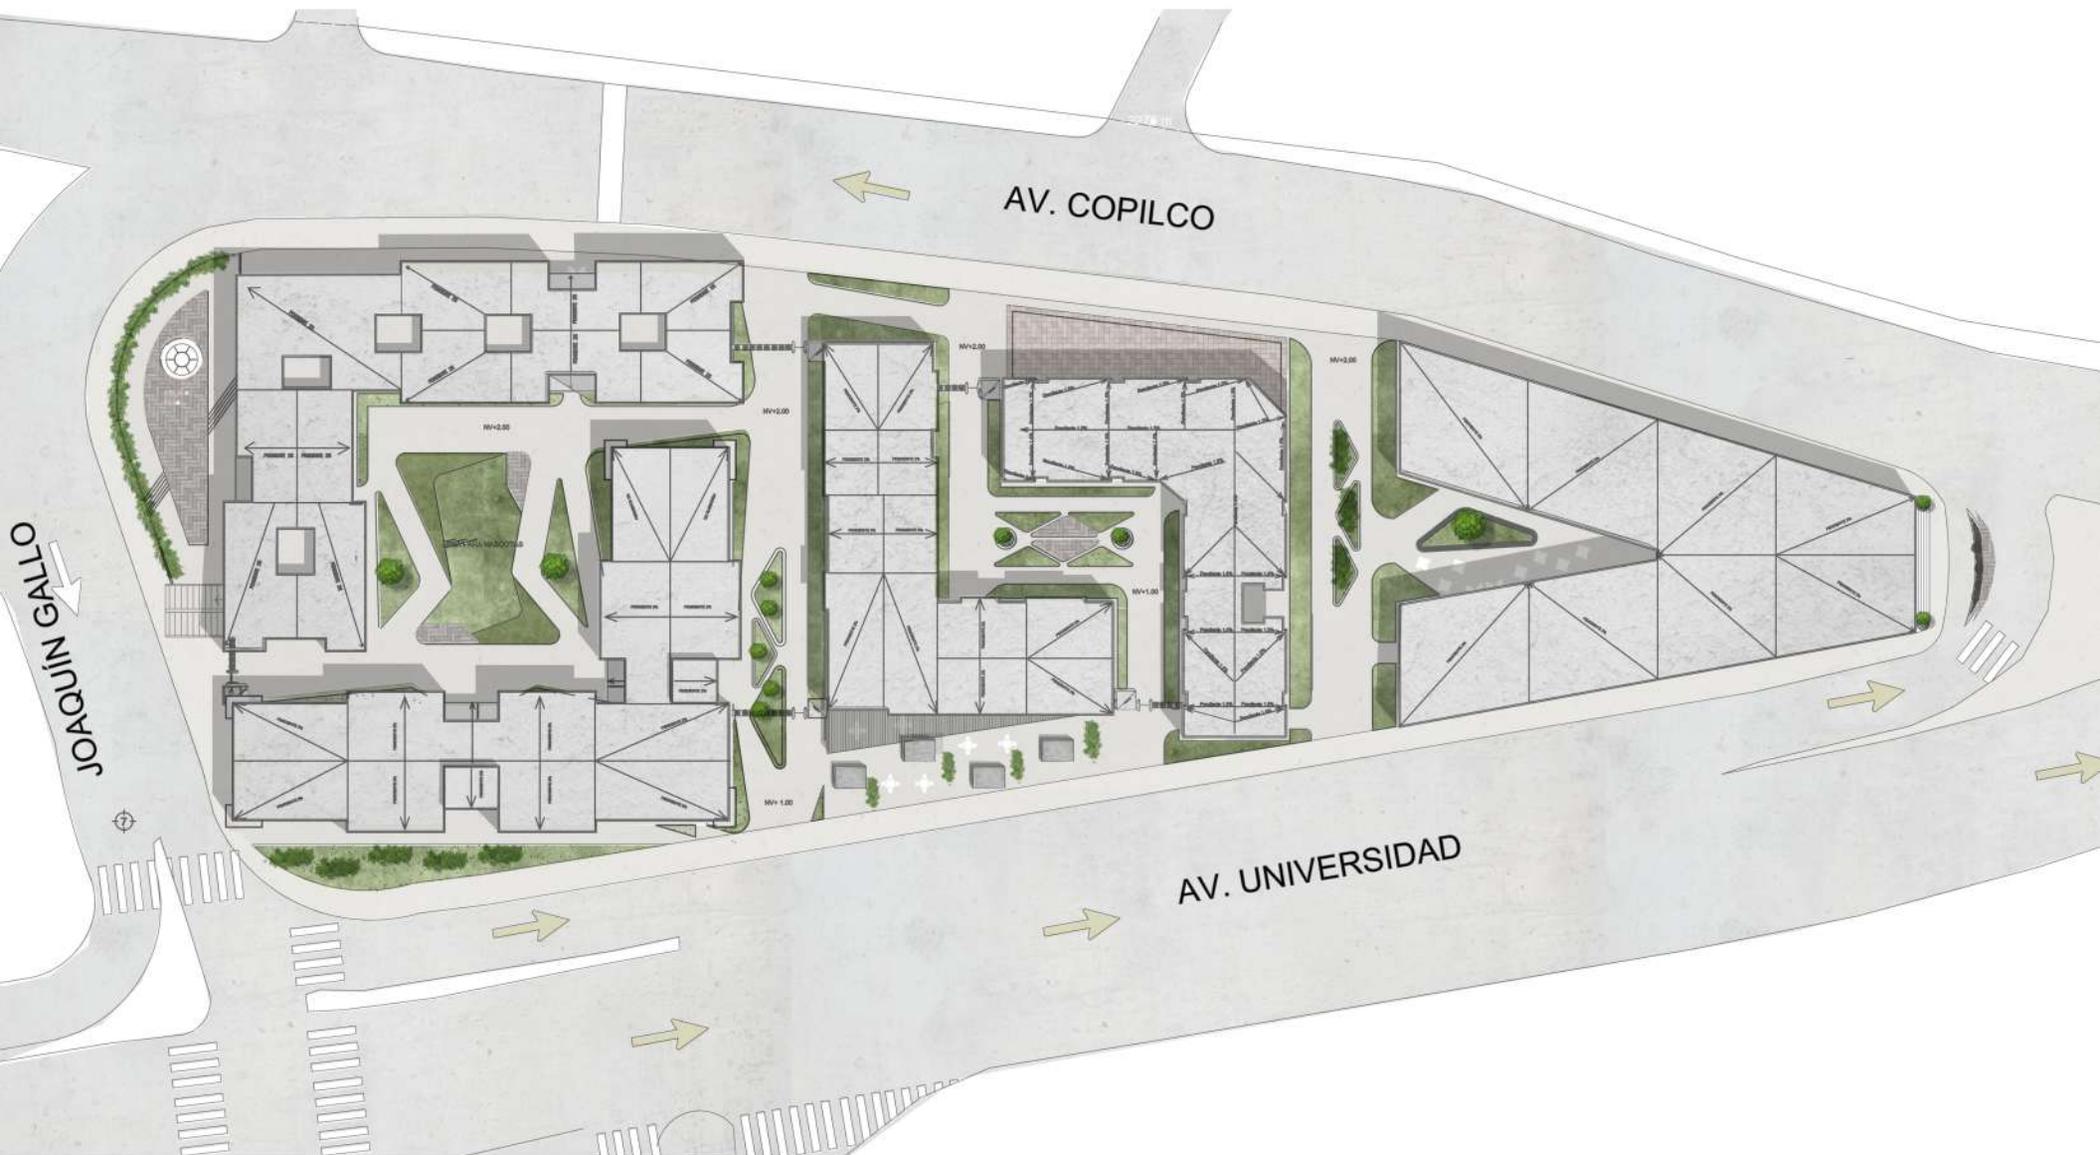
Planta de techos - Conjunto habitacional. Elaboración propia, 2022
